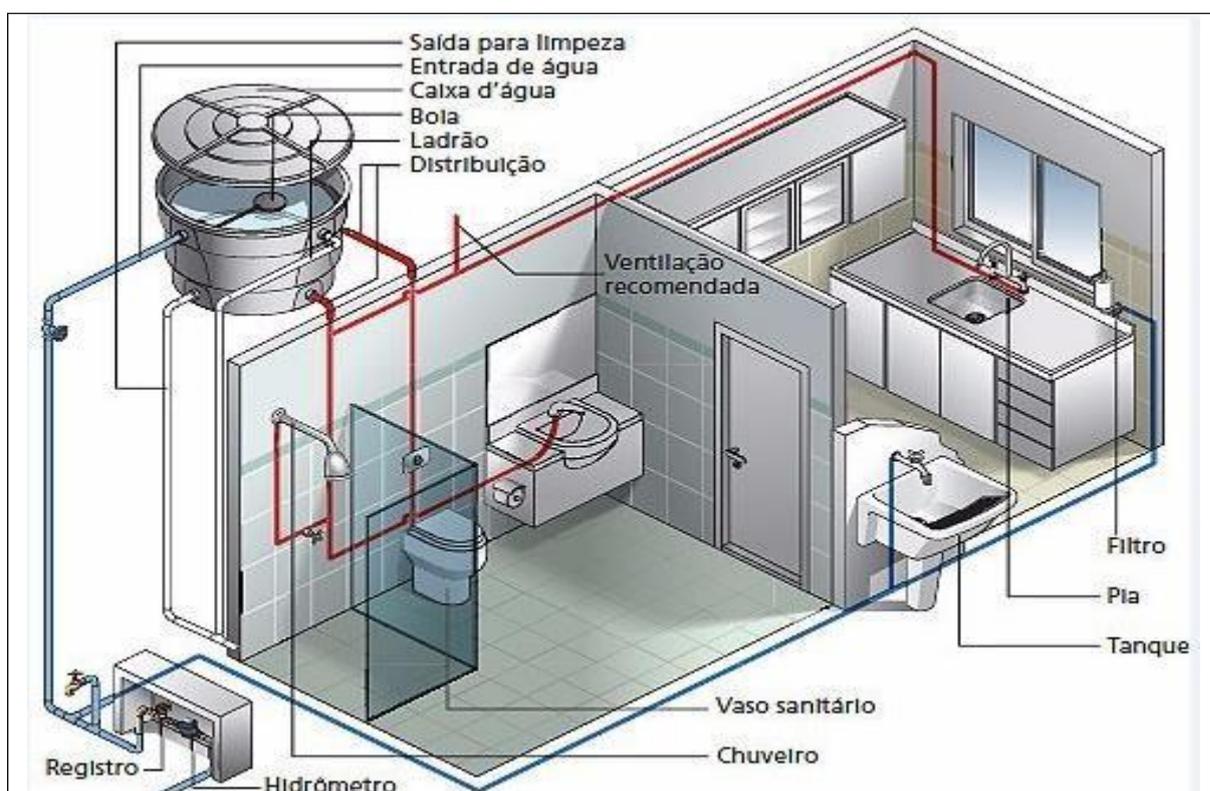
Etapas da instalação hidrossanitária de uma construção convencional
